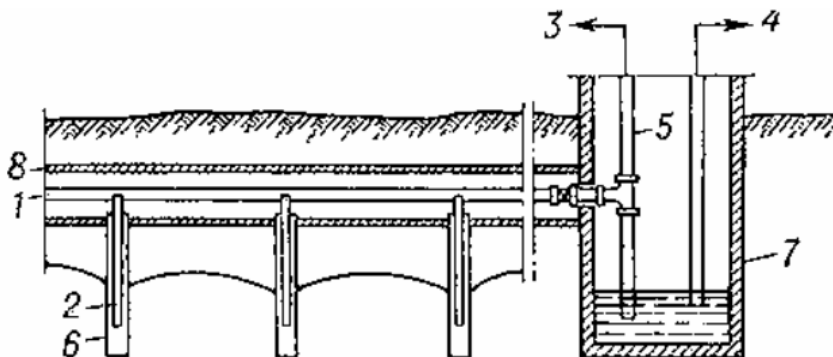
Вертикальний дренаж з сифонним водовідведенням
